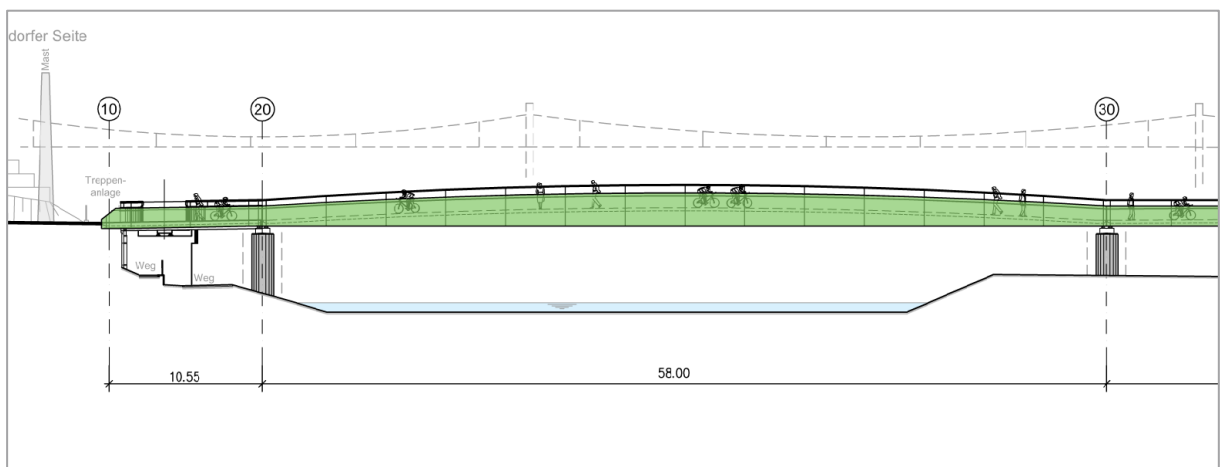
Ausschnitt Überquerung der Sieg, Ansicht aus Anlage 04.01 Bauwerkspläne zum Planfeststellungsentswurf, Brücke: Grundriss, Längsschnitt, Ansicht [4]
